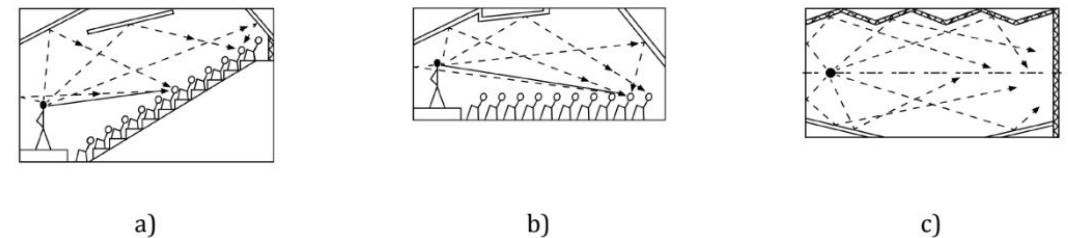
Nützliche Reflexionen für den hinteren Raumbereich (a und b Aufrisse, c Grundriss)
